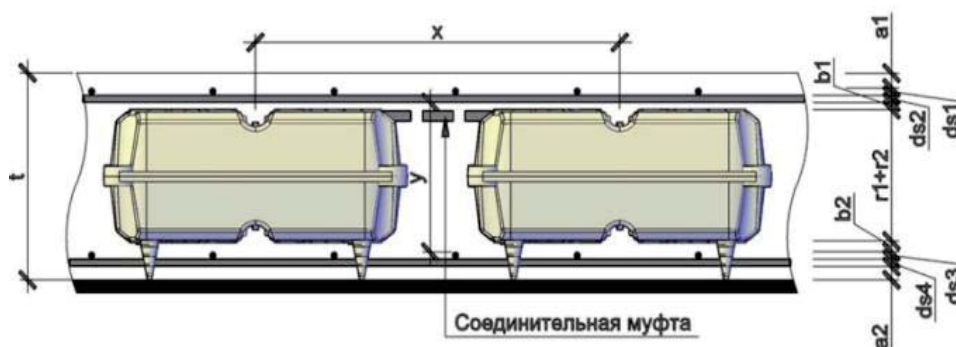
Схема размещения составных пустотообразователей и армирования плиты перекрытия
